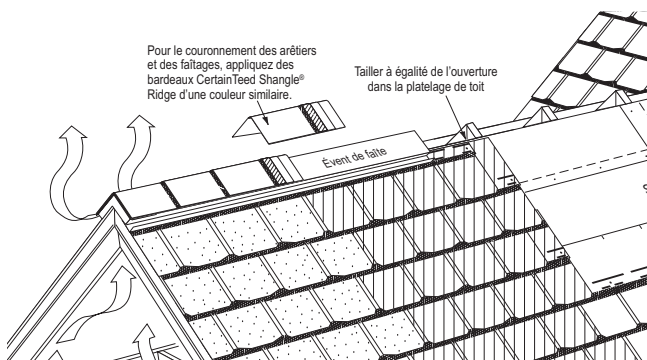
Pose de bardeaux Shangle Ridge sur l'événement de faîteage.
